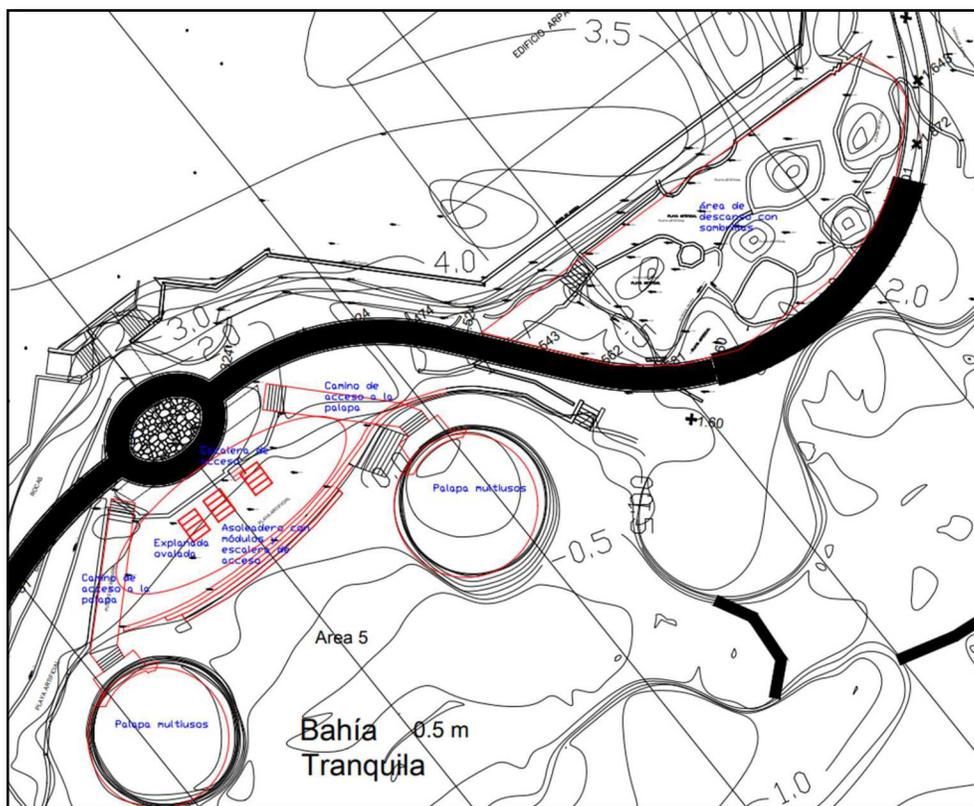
Ubicación de las obras sancionadas y que se pretende su regularización; localizadas en la Bahía Tranquila (señaladas en color rojo). Extracto del Plano de conjunto.
